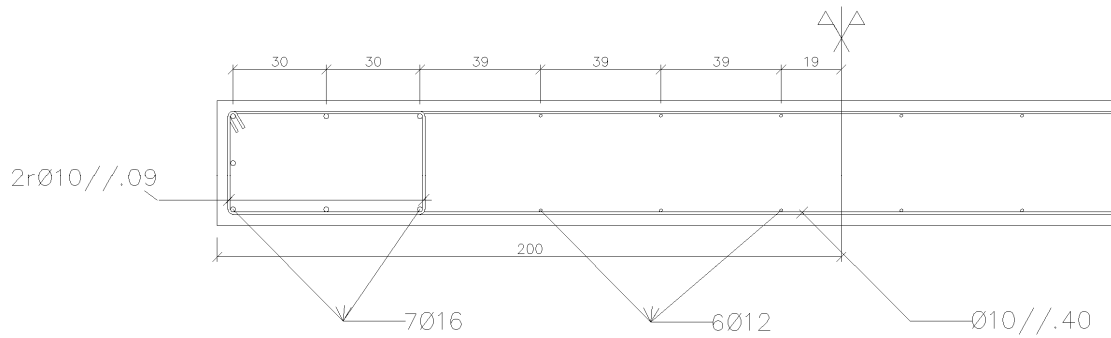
Solução de armadura nas paredes Pa1 e Pa3 (metade da rigidez) [cm]
